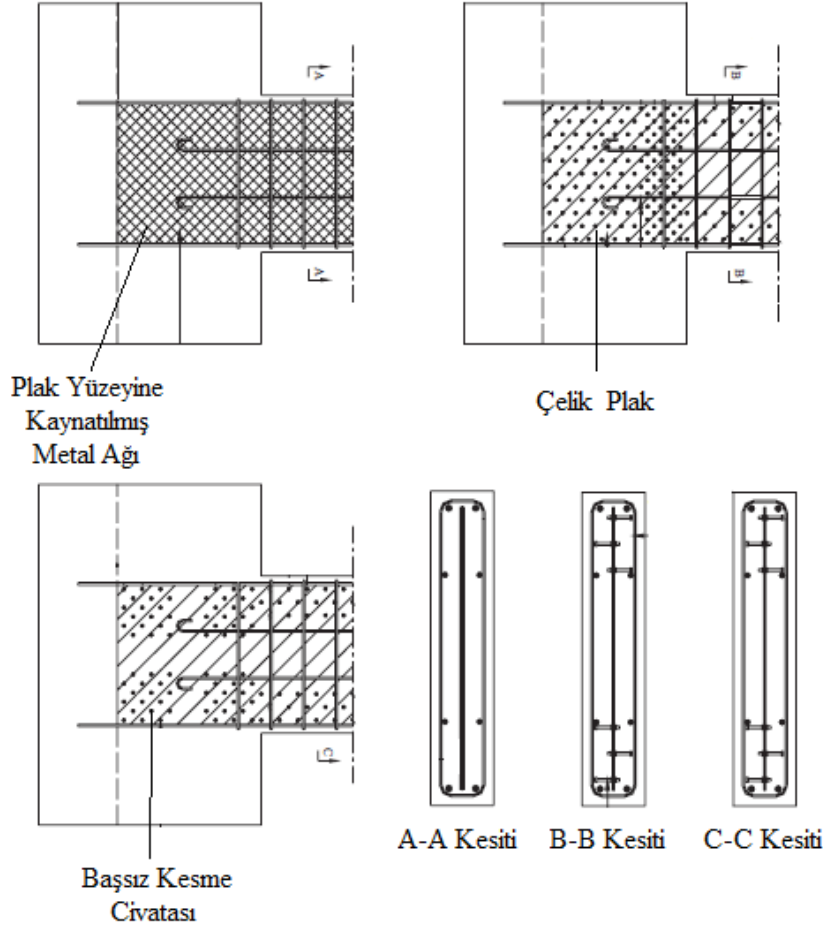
Çelik plakla güçlendirilmiş betonarme bağ kirişi (Su ve Zhu, 2005)
